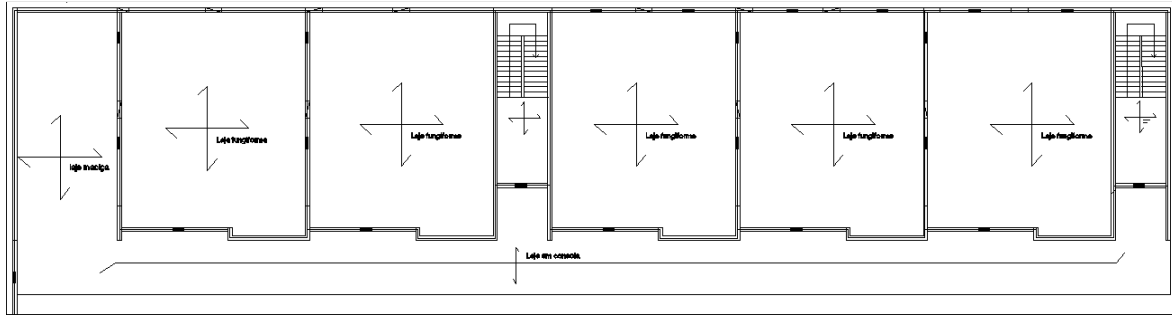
Planta Estrutural do piso1 do módulo B (s/escala)
